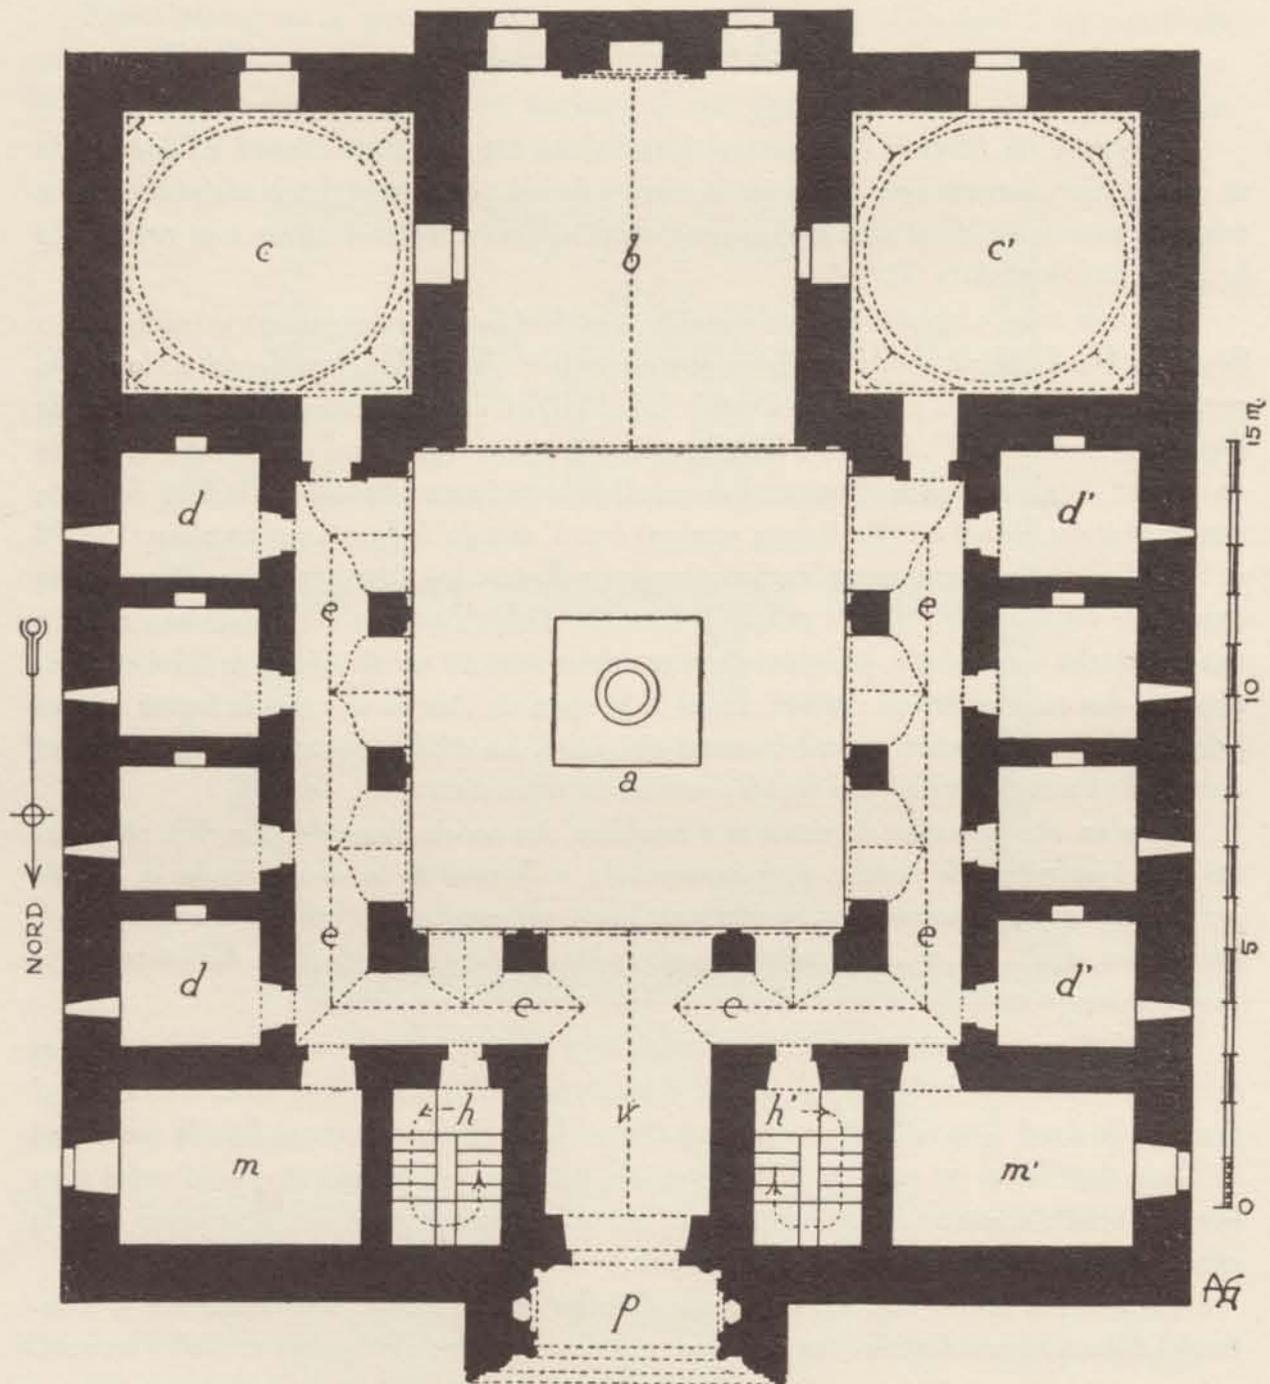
AK MEDRESE: Plan du rez-de-chaussée.
